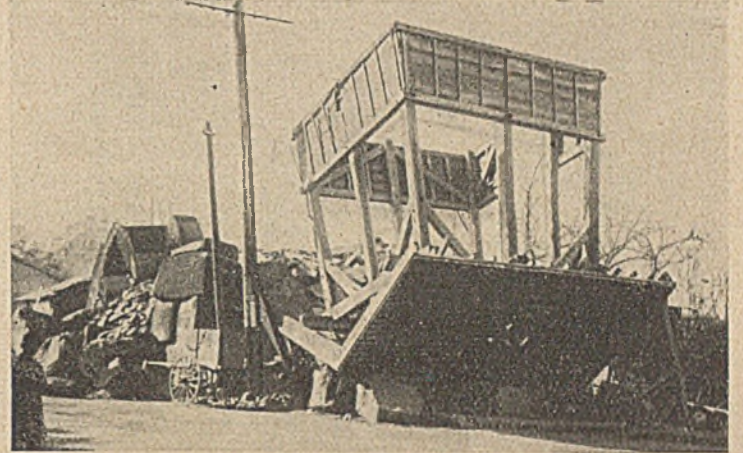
Gegenstück zu 9a. Gut verstreber Holzaufbau, bei Einsturz des massiven Unterbaus kaum beschädigt.
